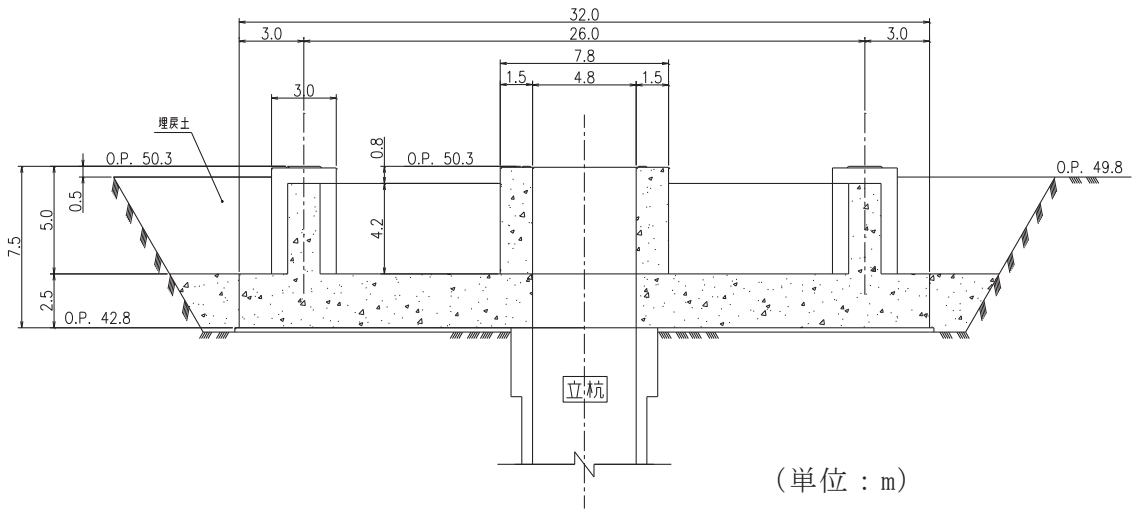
第 1 号機排気筒の基礎断面図 (A-A 断面)
